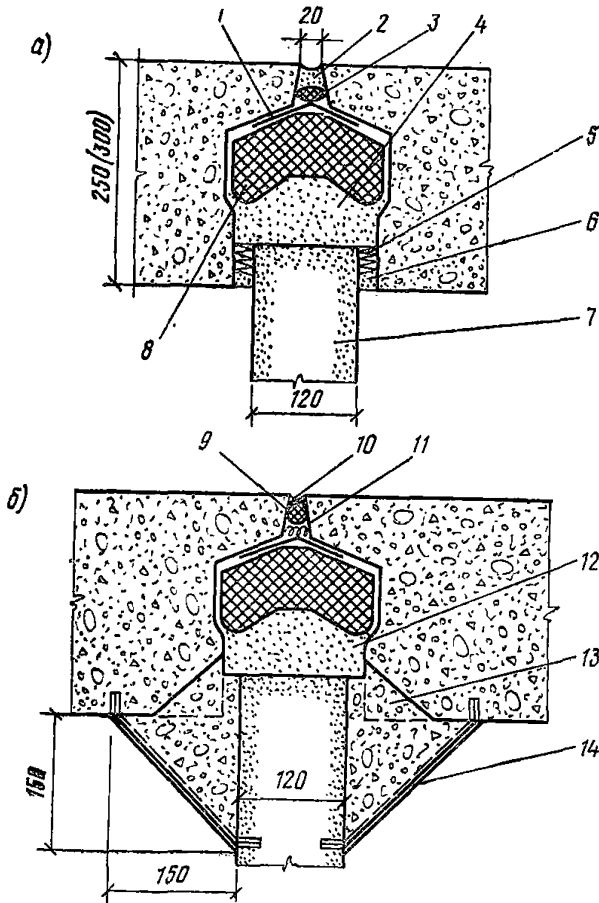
Утепление рядового вертикального стыка наружных стеновых панелей
